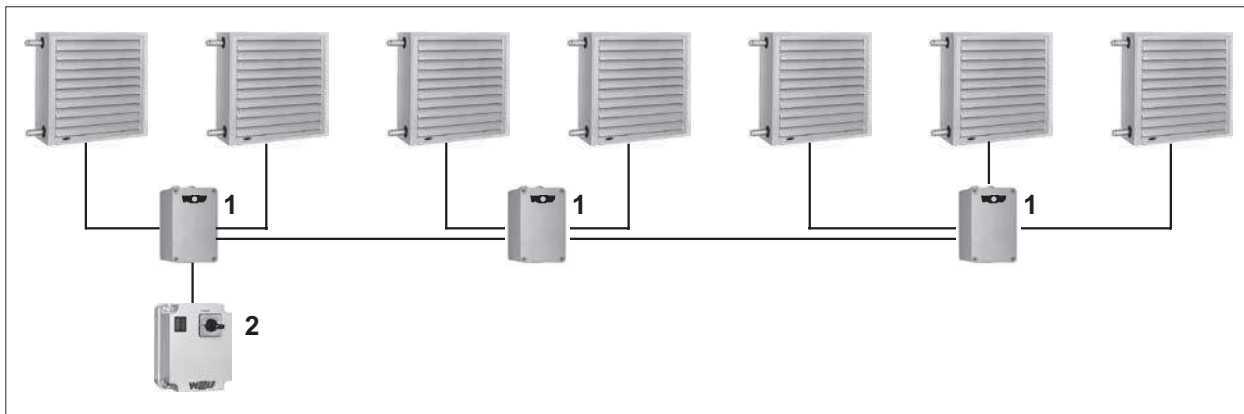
Подключение 7 воздухонагревателей с 3 соединительными клеммными коробками к одному управляющему или регулиющему устройству
